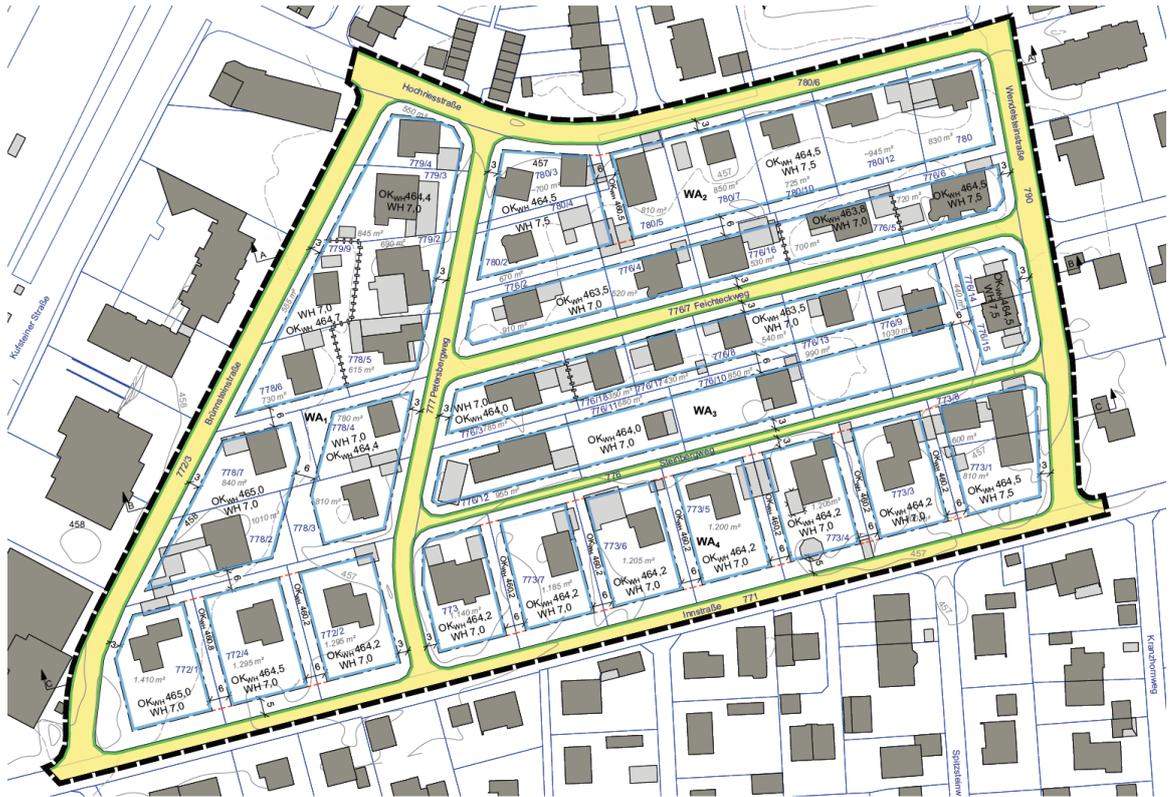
Planzeichnung Neuaufstellung BP „Raubling - Ost Teil III“ - ohne Maßstab!
